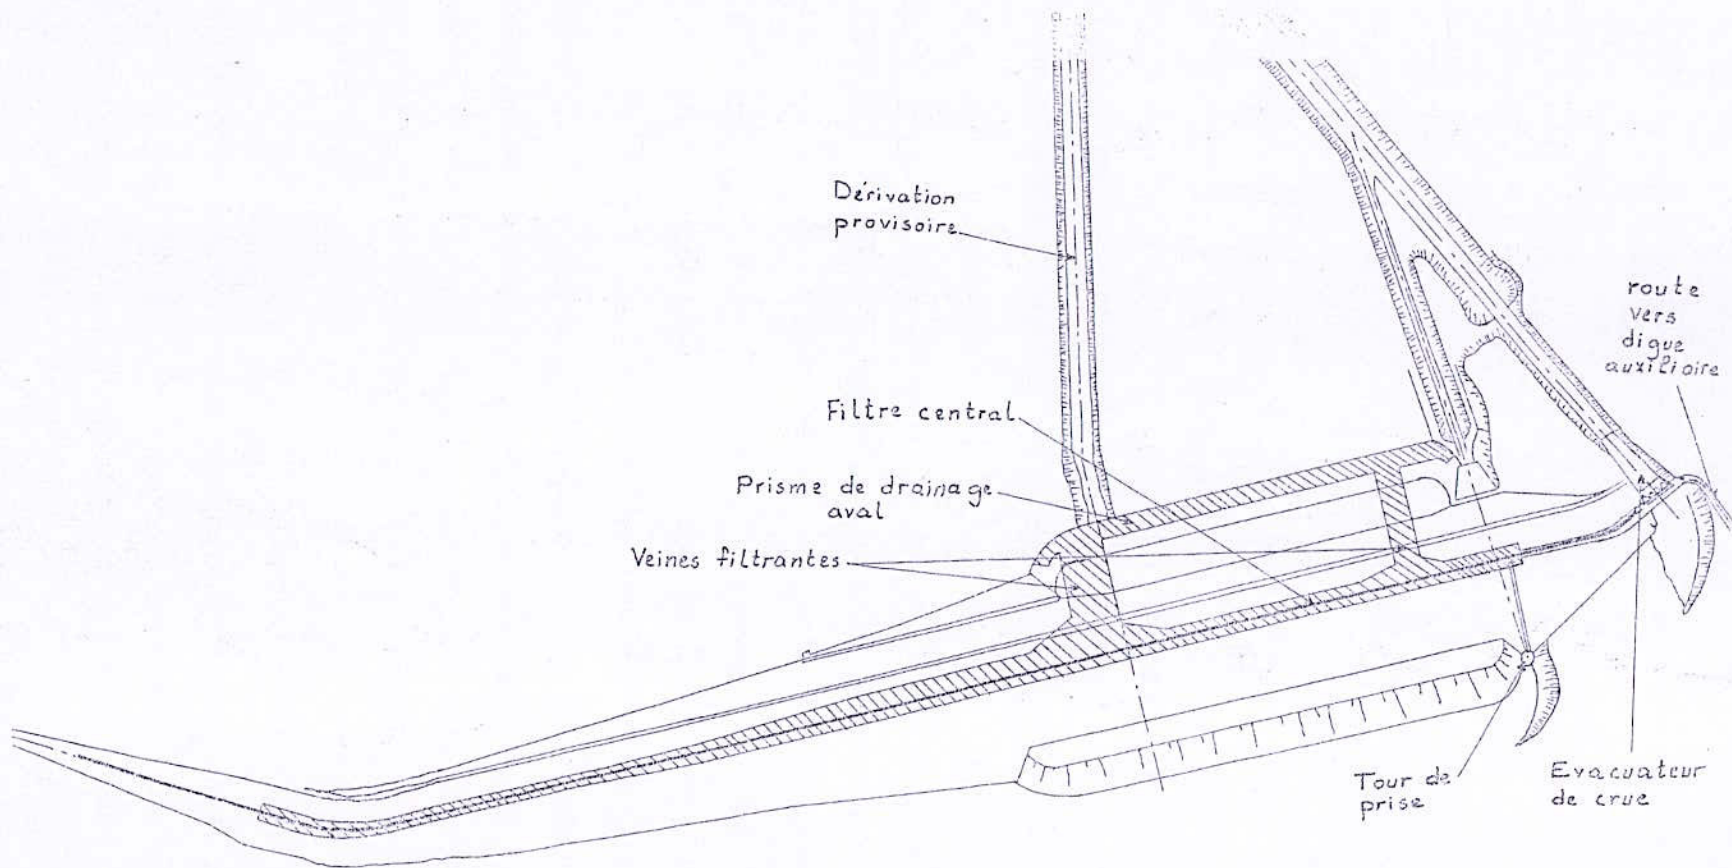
Vue en plan et détail du drainage (filtre, veines...) et des ouvrages annexes.
